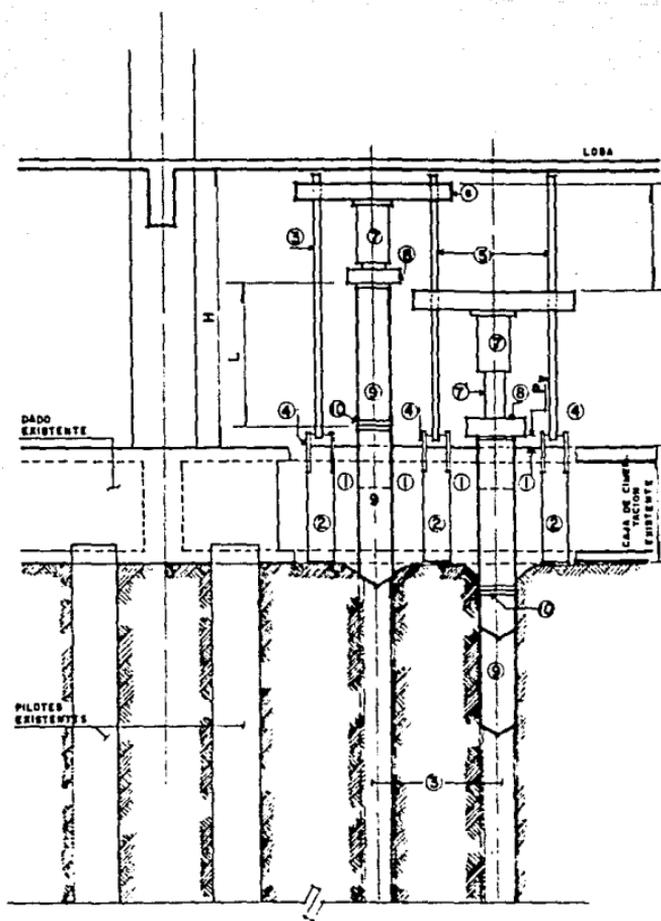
ANCLAJE DE LOS ELEMENTOS DE REACCION EN LA CIMBENTACION
